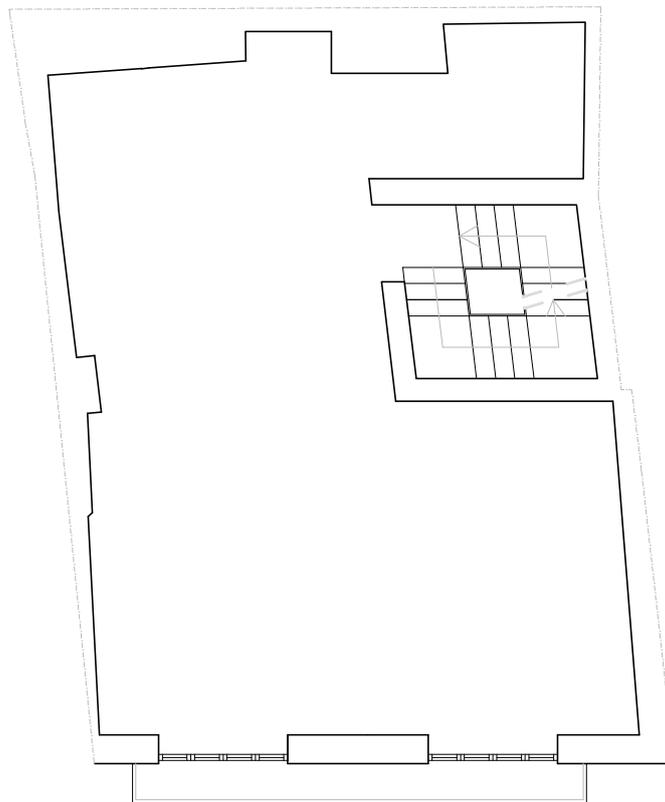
Planta Primera Edificio Actual, Fuente: Elaboración Propia
